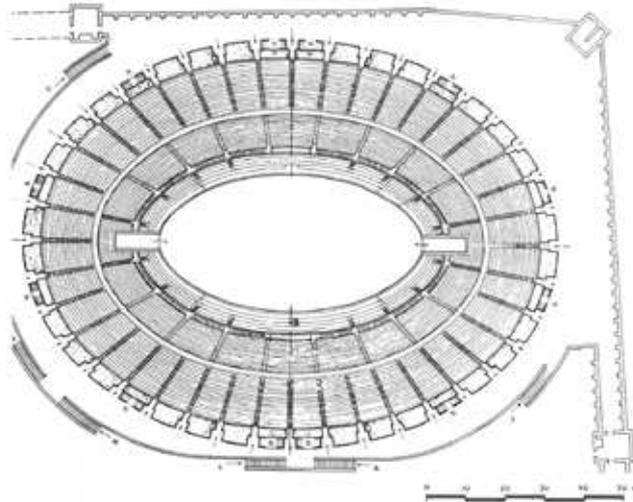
Pianta dell'anfiteatro di Pompei.
